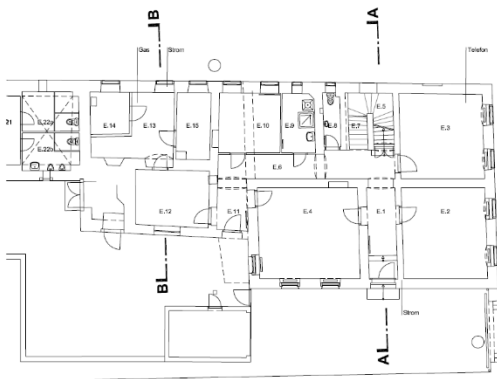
Grundriss EG, Pfarrhaus Oggau.
